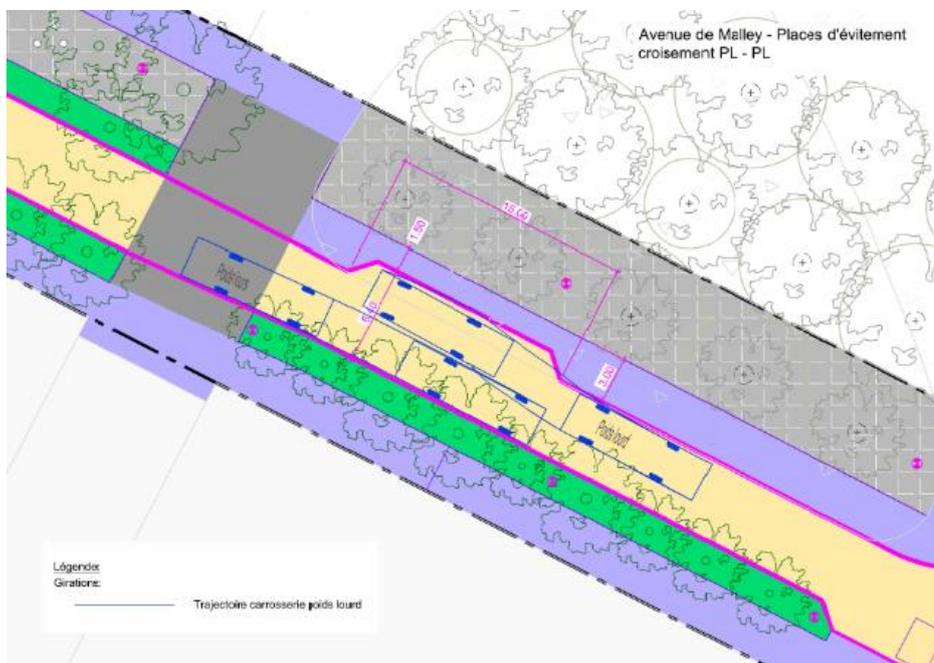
Zone d'évitement pour croisement PL-PL, Groupement Mhust, 2022
